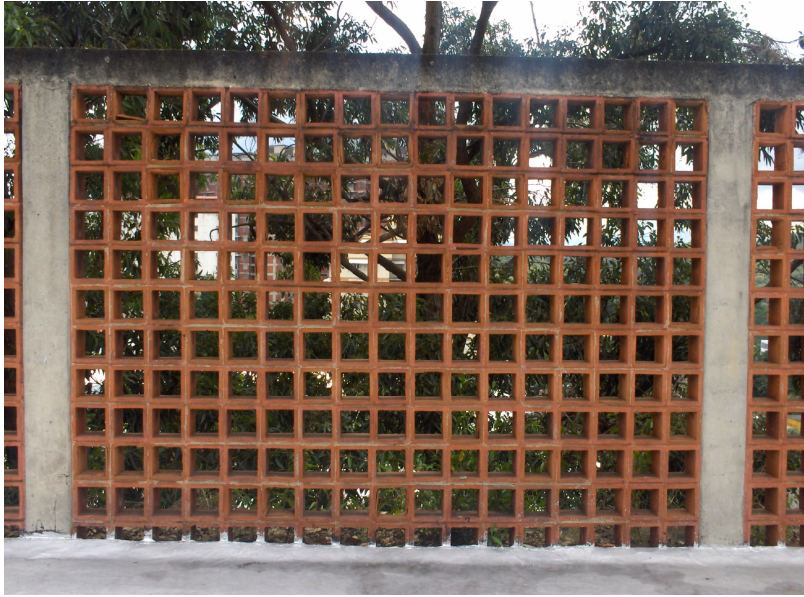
Ventilación con bloques de arcilla. Última planta.
